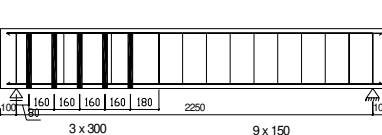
Pemasangan Sampel Balok Pada Loading Frame
